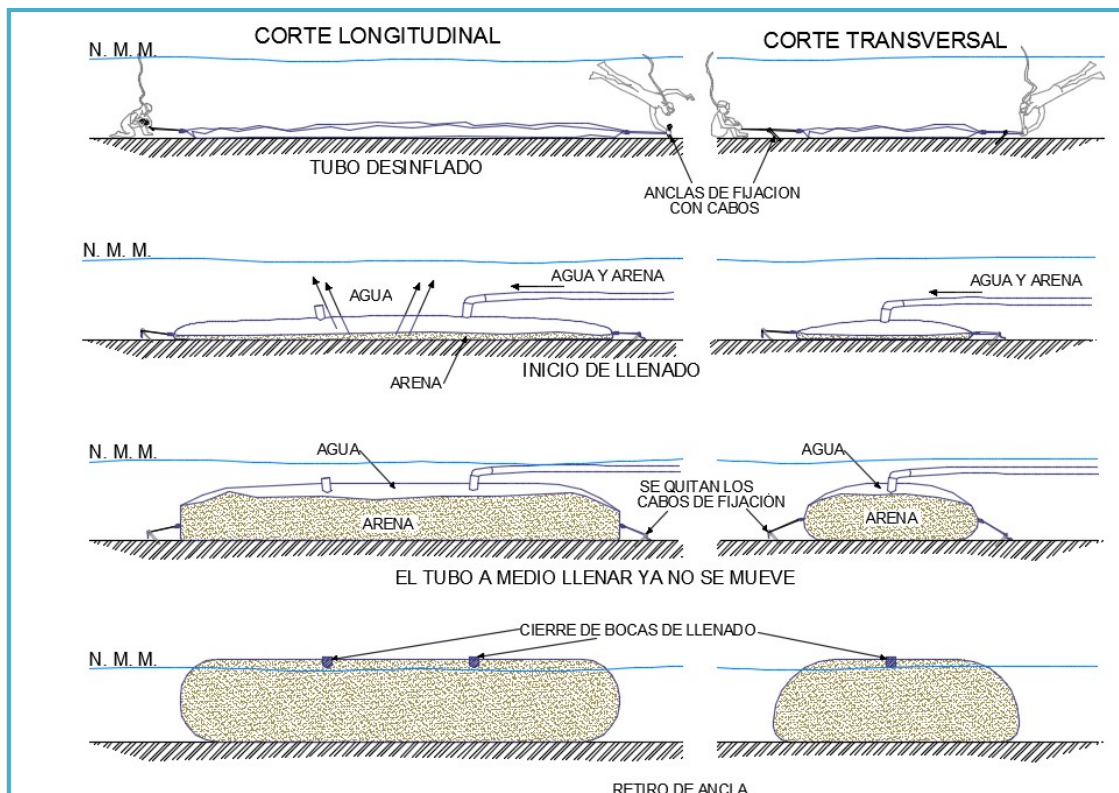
PROCESO TÍPICO DE LLENADO DE LOS TUBOS DE GEOTEXTIL PARA LA SECCIÓN DE REFUERZO
